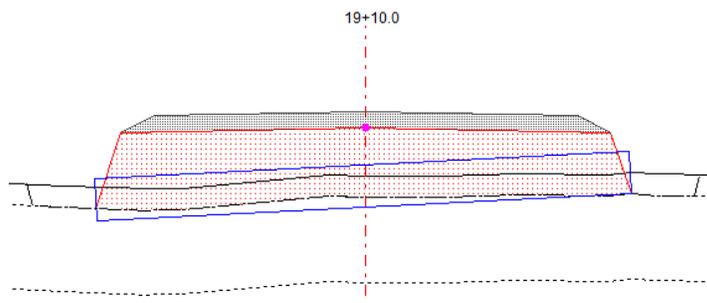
Elevación de Drenaje controlada por “Catch Points”
